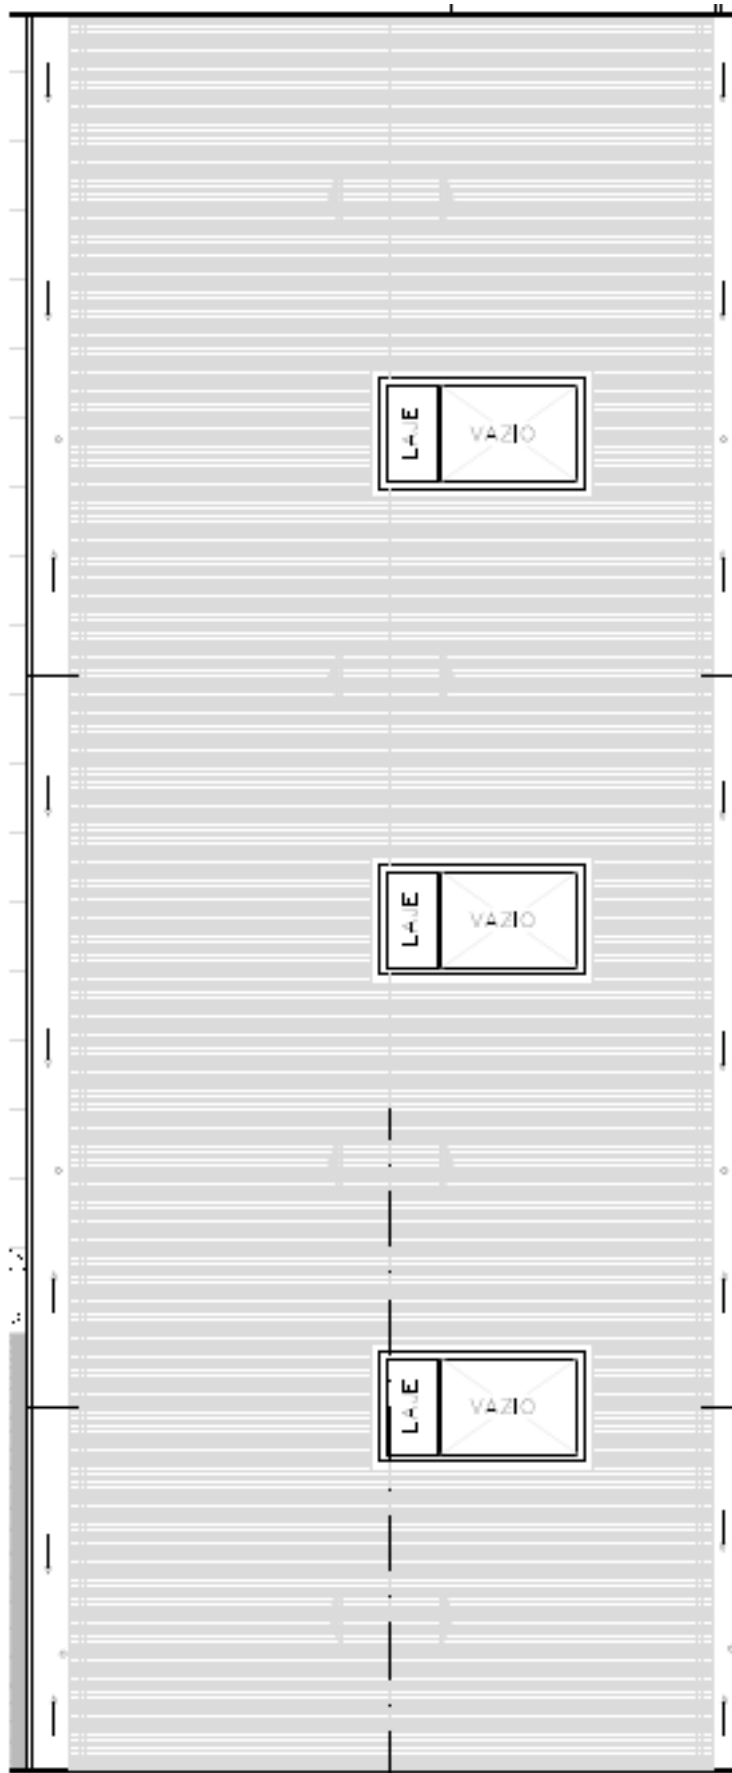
Planta de cobertura do bloco D, FACE, UnB (fonte: CEPLAN, UnB, 2015)
